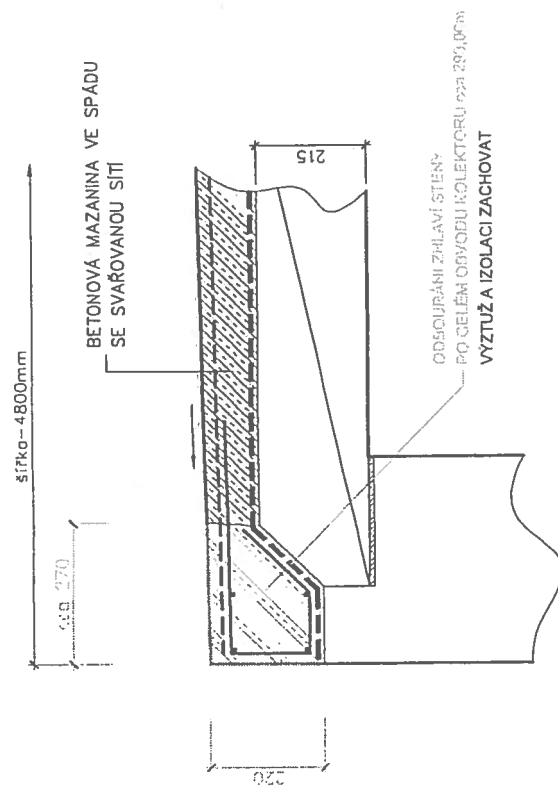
DETAIL ÚPRAVY KOLEKTORU M 1:25
